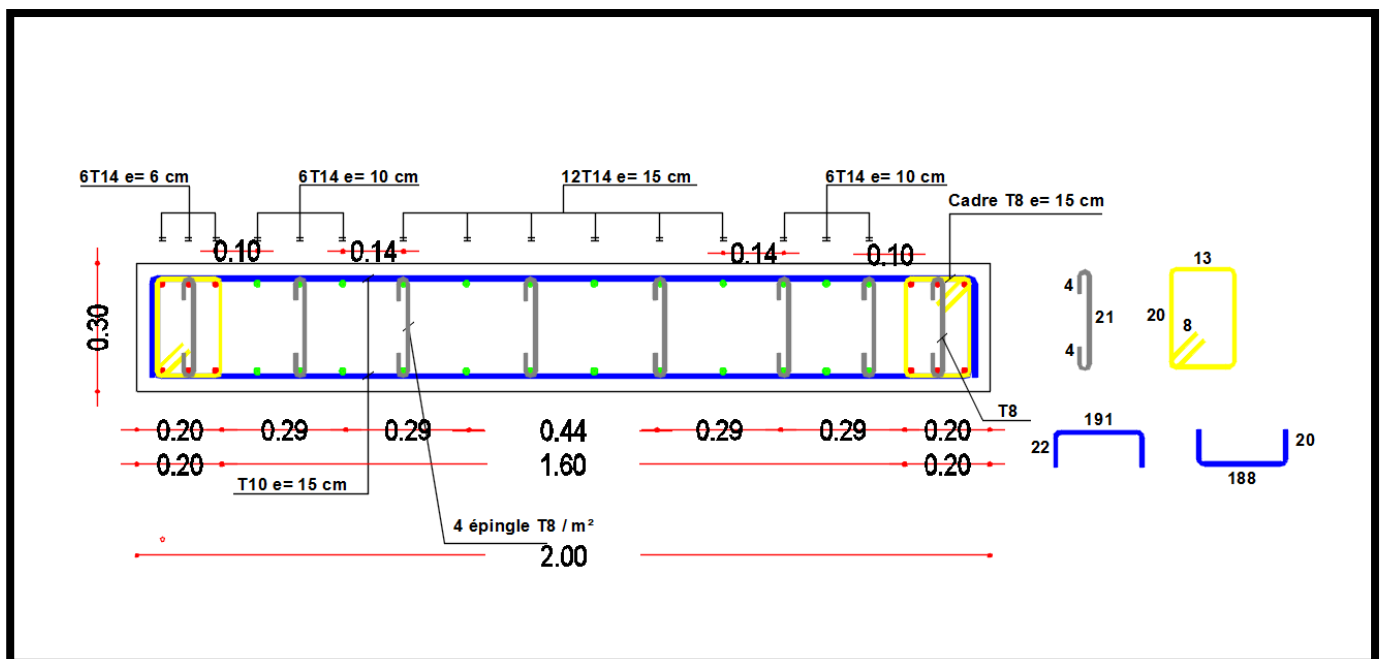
Coupe horizontale du ferrailage des voiles sens Y-Y type (1; 2)
